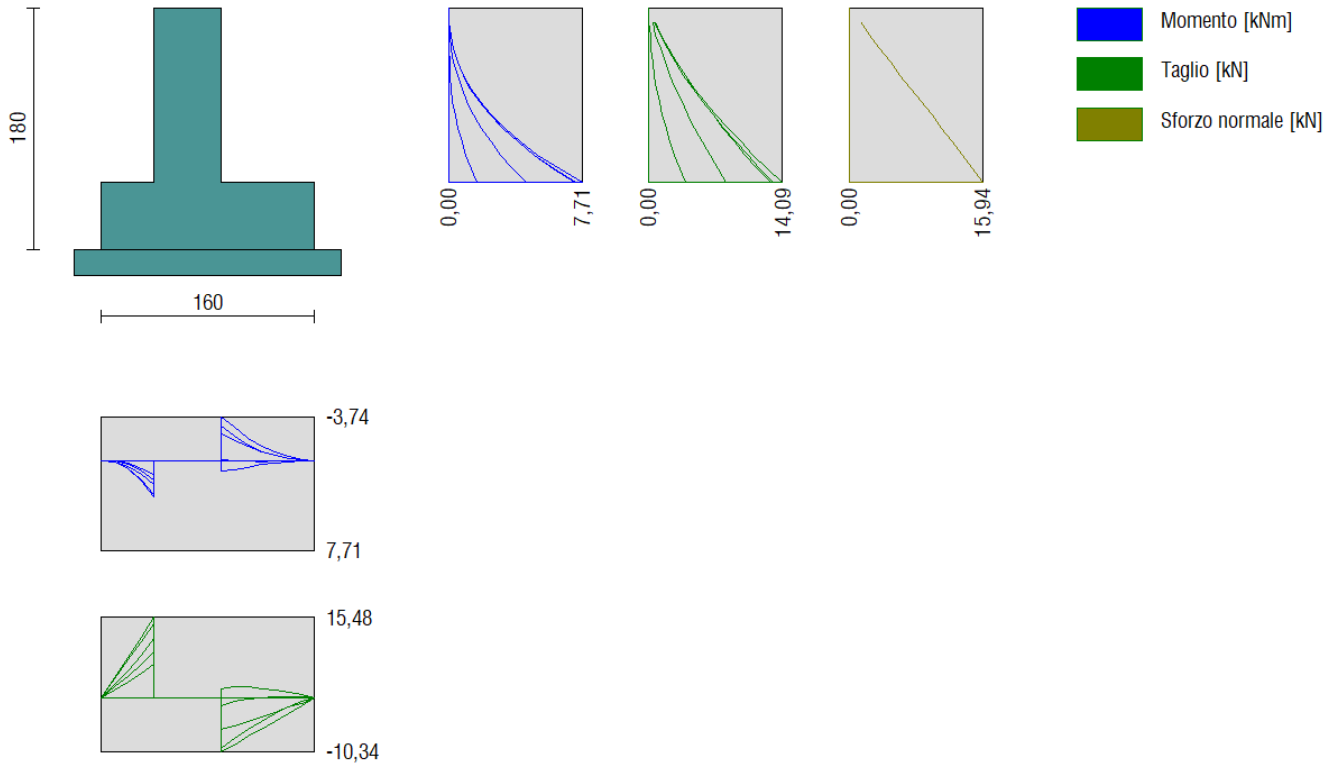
Involuppo delle sollecitazioni sul paramento e sulla piastra di fondazione del muro di sostegno
